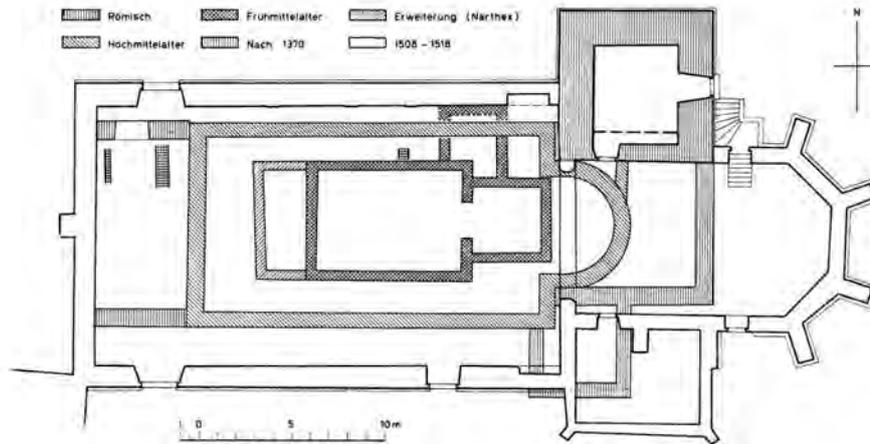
Elgg ZH, Reformierte Kirche. Bautappenplan. – 1:400.
